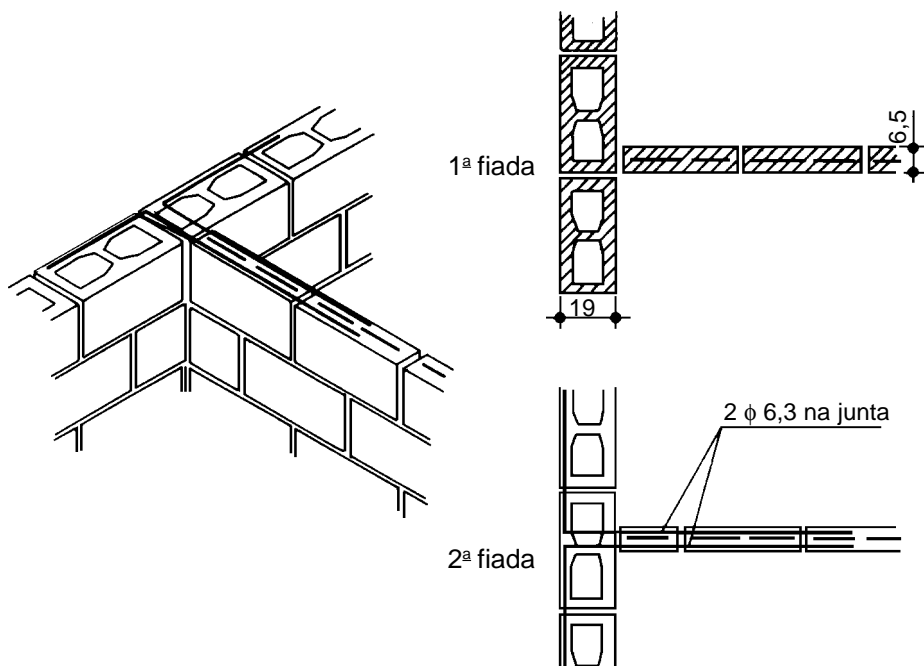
Amarração dos painéis com armadura (Cf. Ref. 5)
